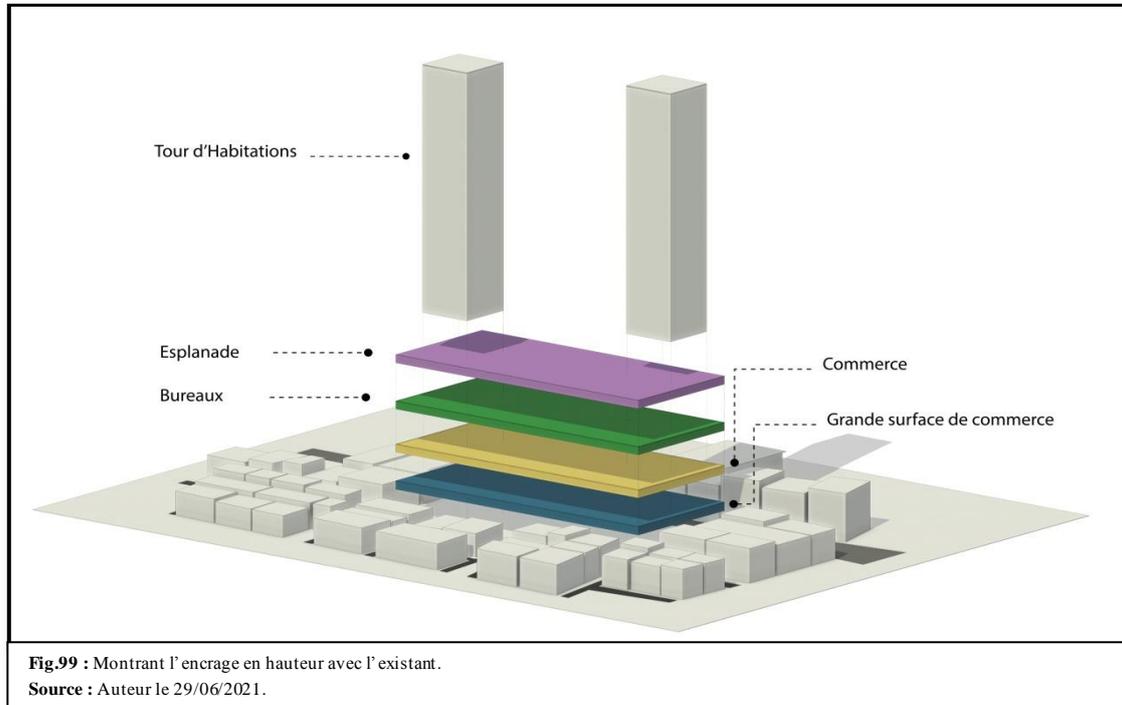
Montrant l'encrage en hauteur avec l'existant.
